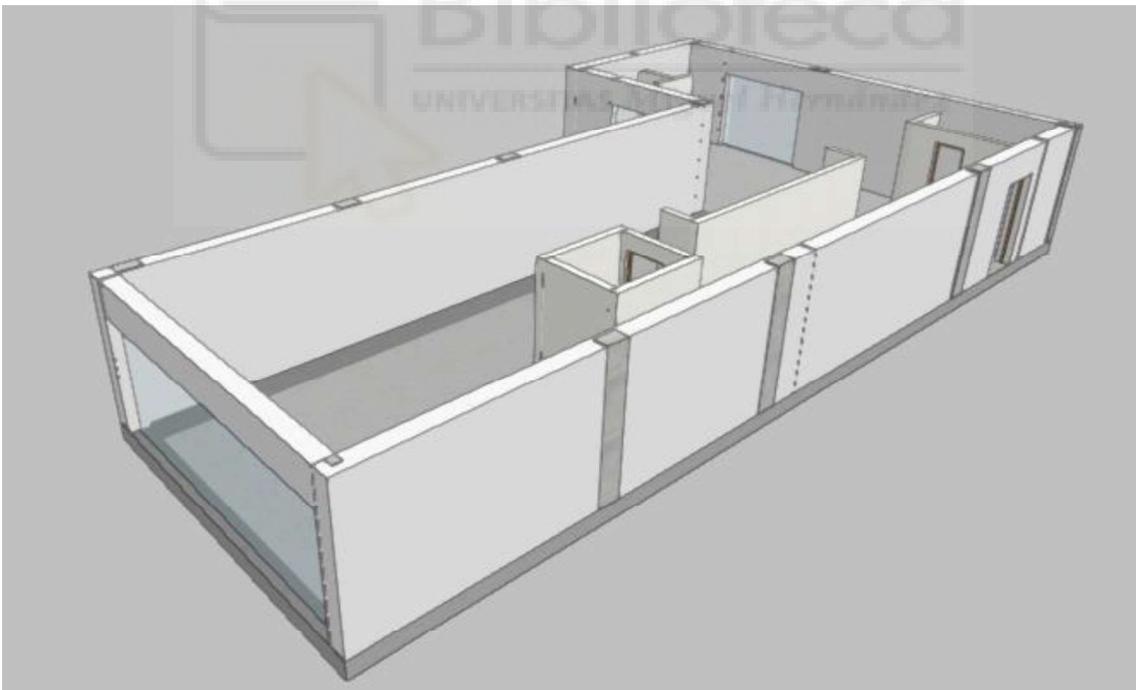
Distribución Planta Baja. Vista: En 3D. IFC Builder
